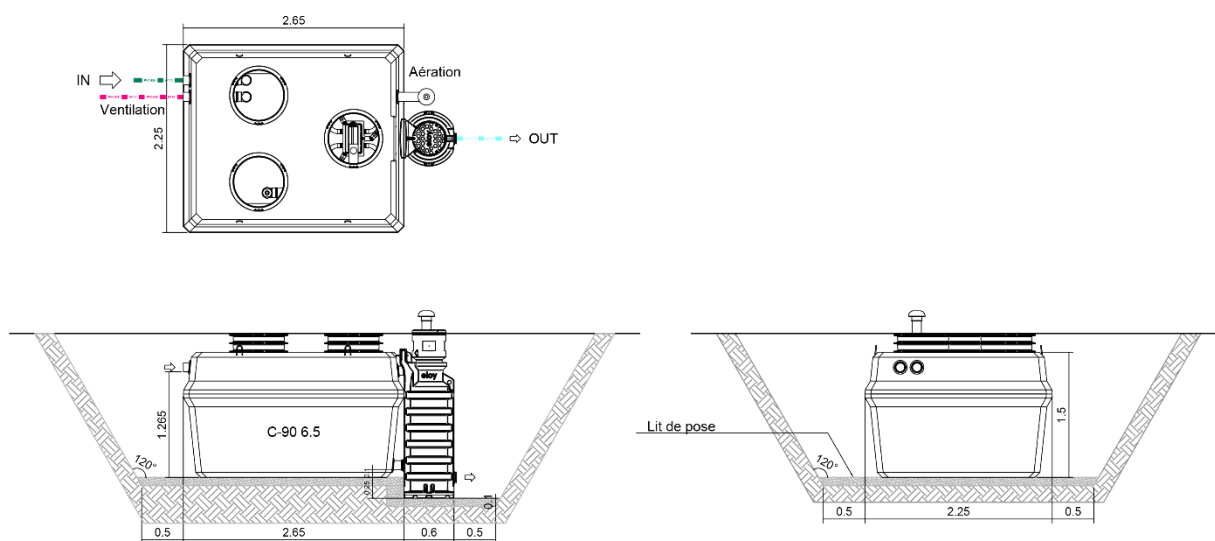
plan d'implantation chambre d'échantillonnage PE
